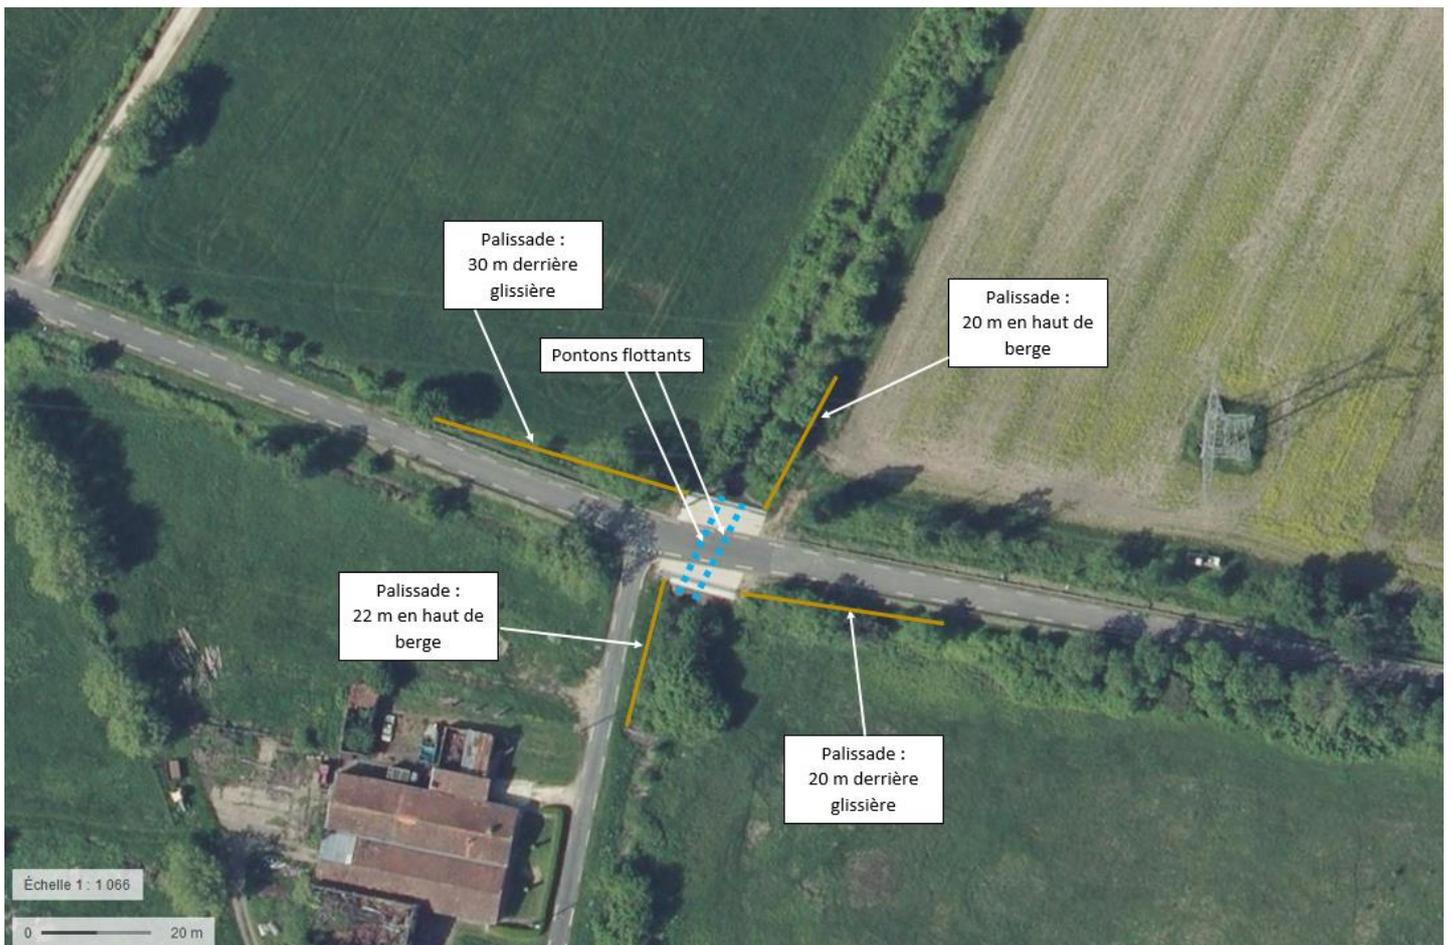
Schéma de principe de rétablissement de la continuité écologique de l'ouvrage hydraulique, jalle de Cante-Loup
